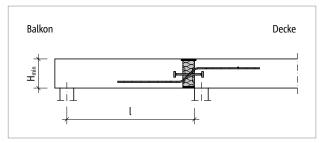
Schöck Isokorb® T Typ QP: Statisches System
